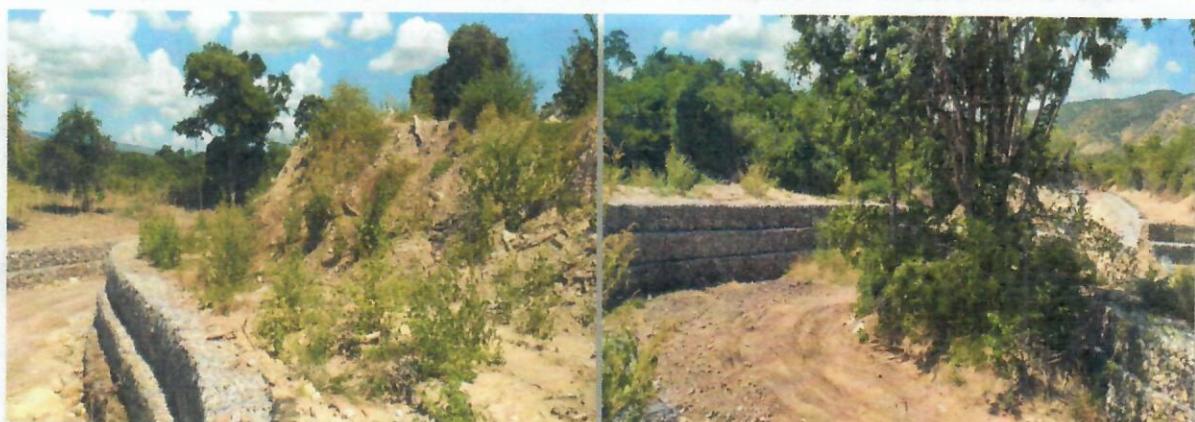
Material forestal intervenido por maquinaria para la construcción de gaviones, punto 5, Arroyo Pozo Hondo
